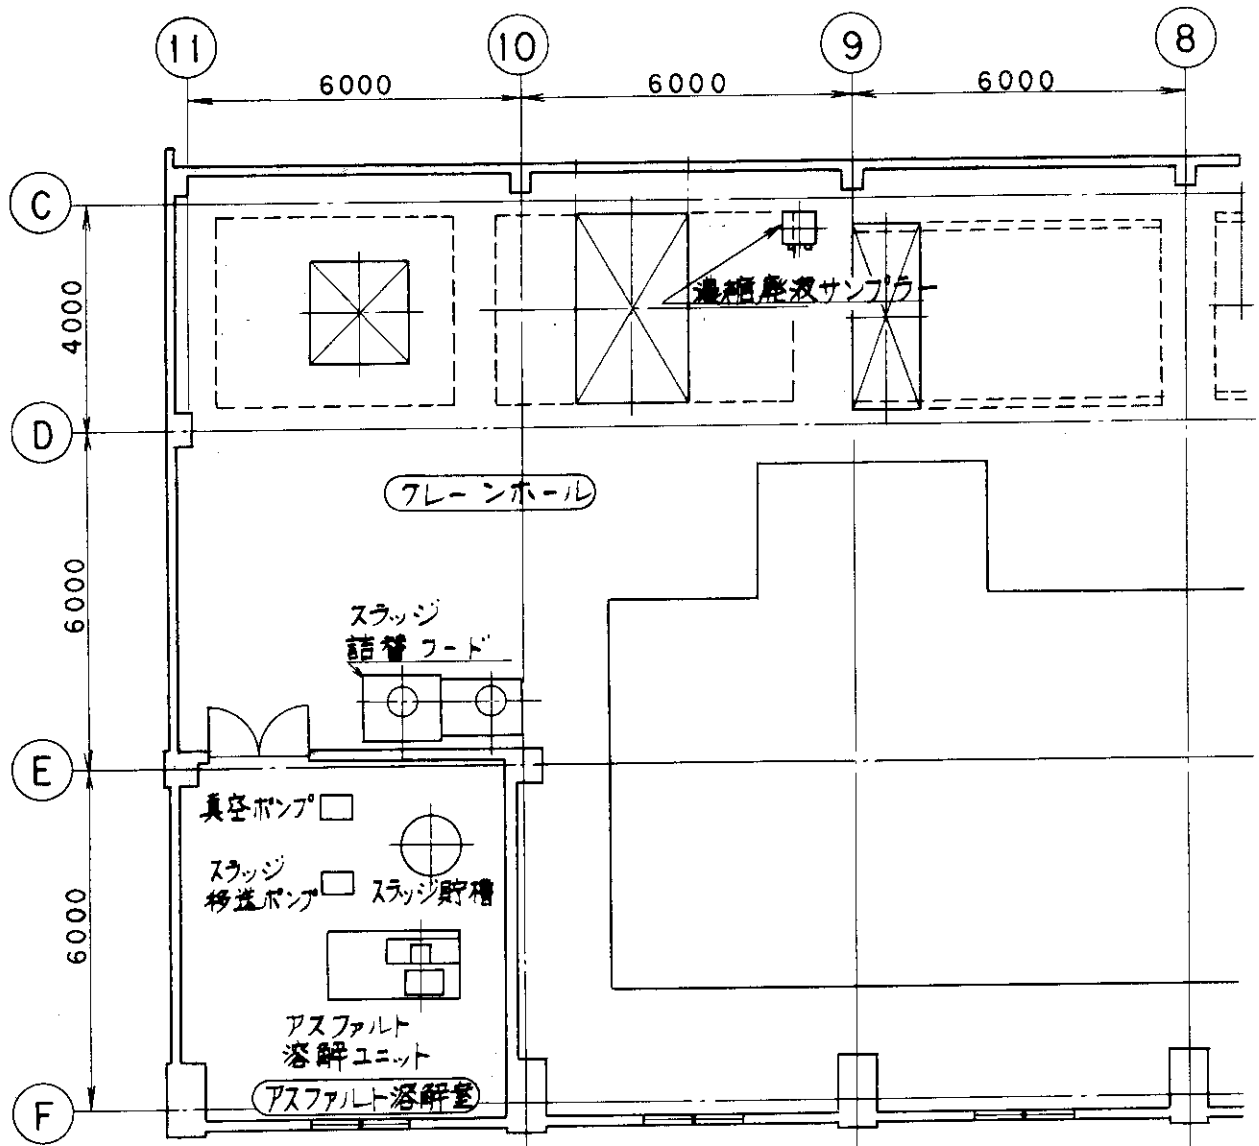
アスファルト固化処理設備機器配置図 (その1) 2階平面
